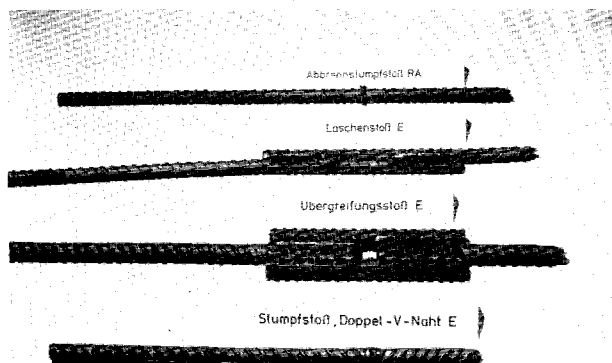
Schweißverbindungen von Betonstahl
